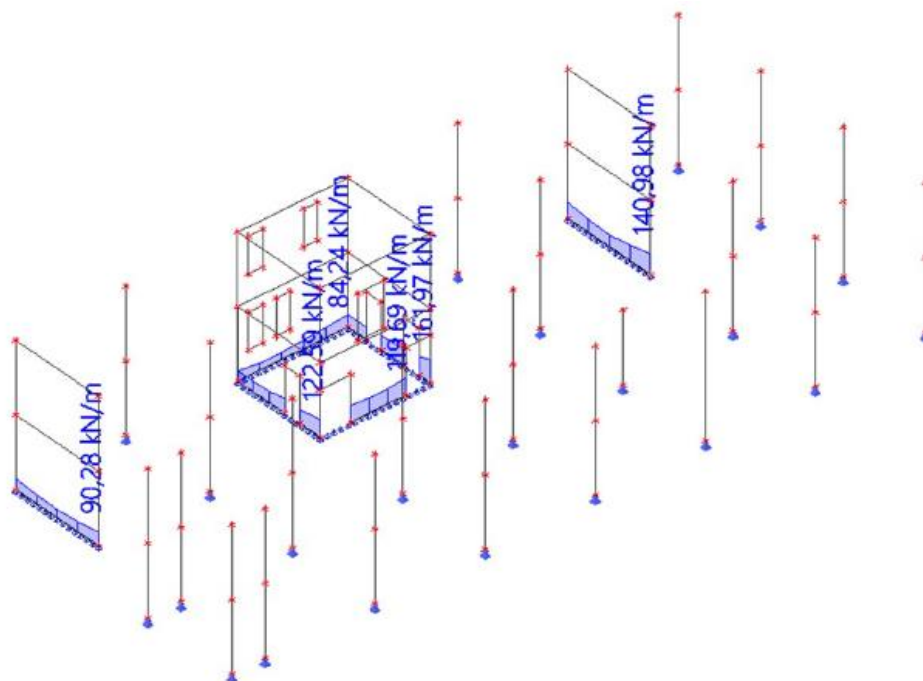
půdorys 1.NP konstrukčního systému – model C
